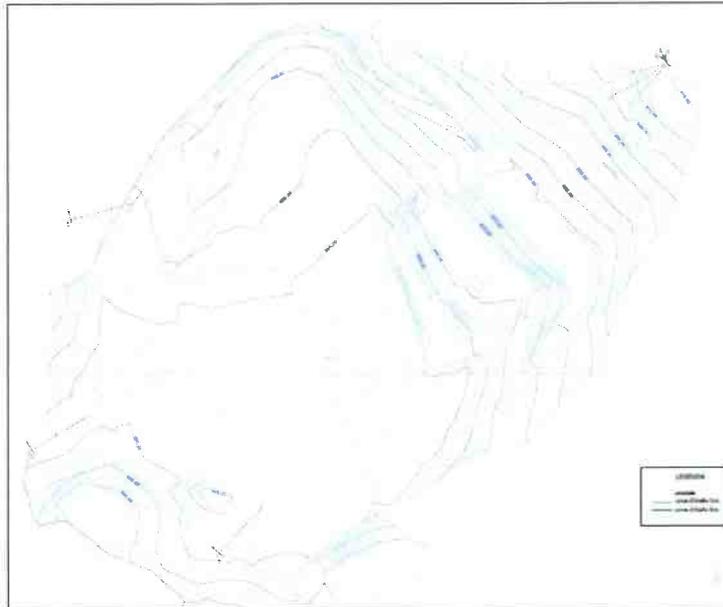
Planimetria stato di fatto (da Tav. 2 allegata allo SPA)
